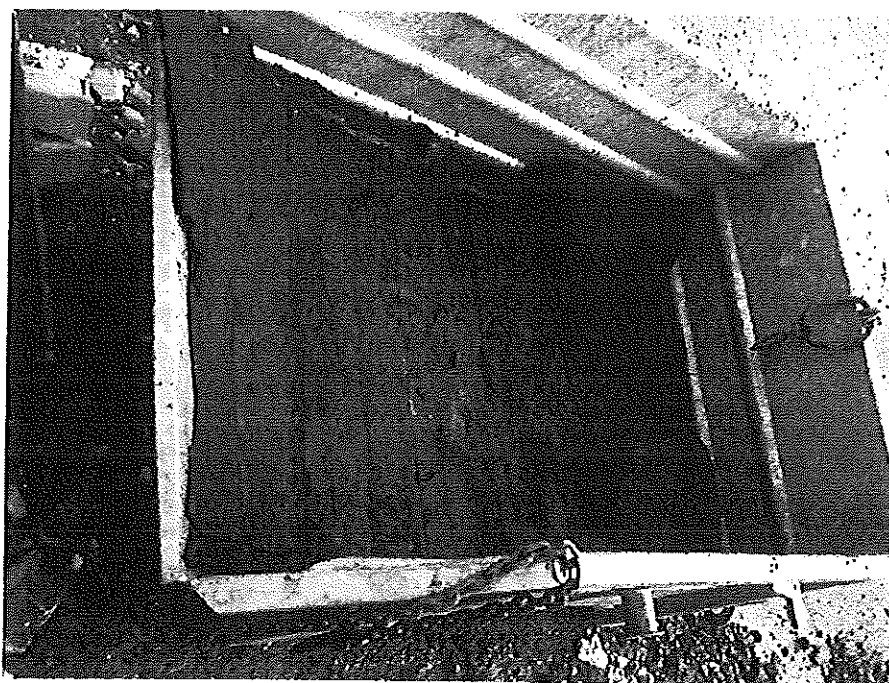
Rückbau alte Übergabestation RWE, Separierung Dach, Blick in Container Dachpappen (Ortstermin 09.03.2005)
